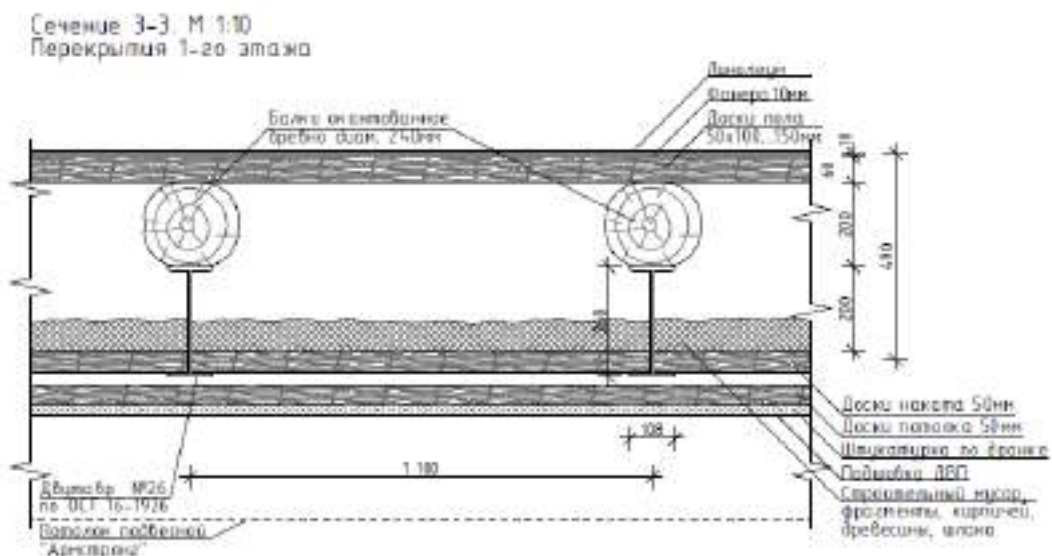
Состав междуэтажного перекрытия в осях 1-3
